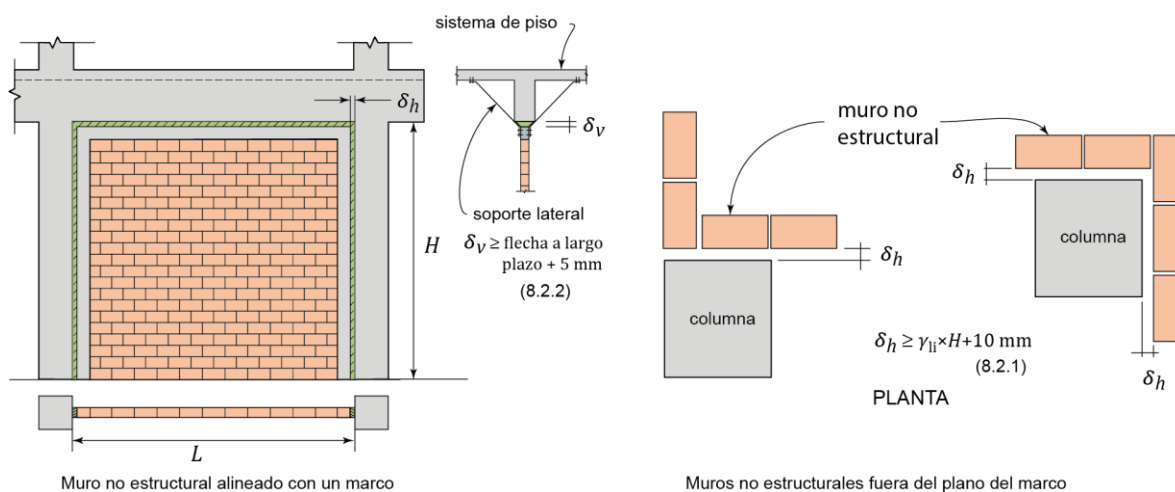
Holguras entre muros no estructurales y columnas y vigas
